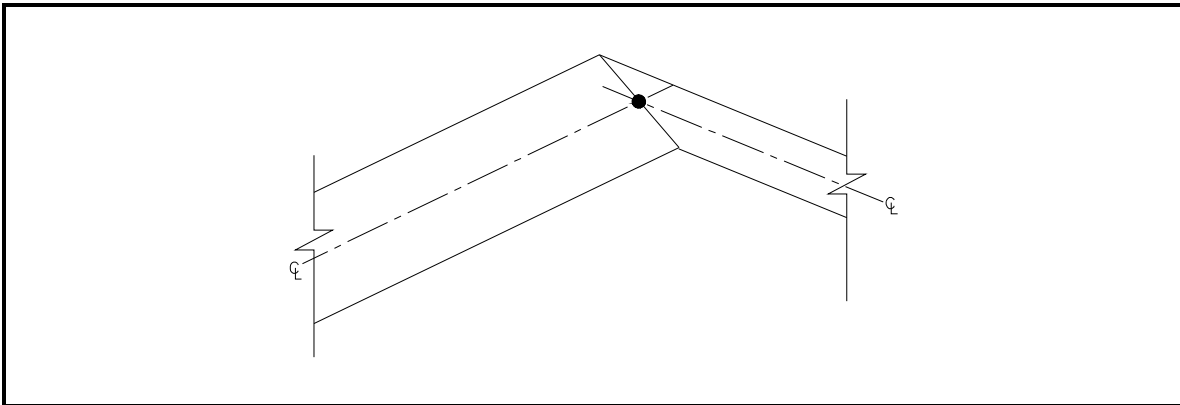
A Joint de rupture de pente taillé à onglet
